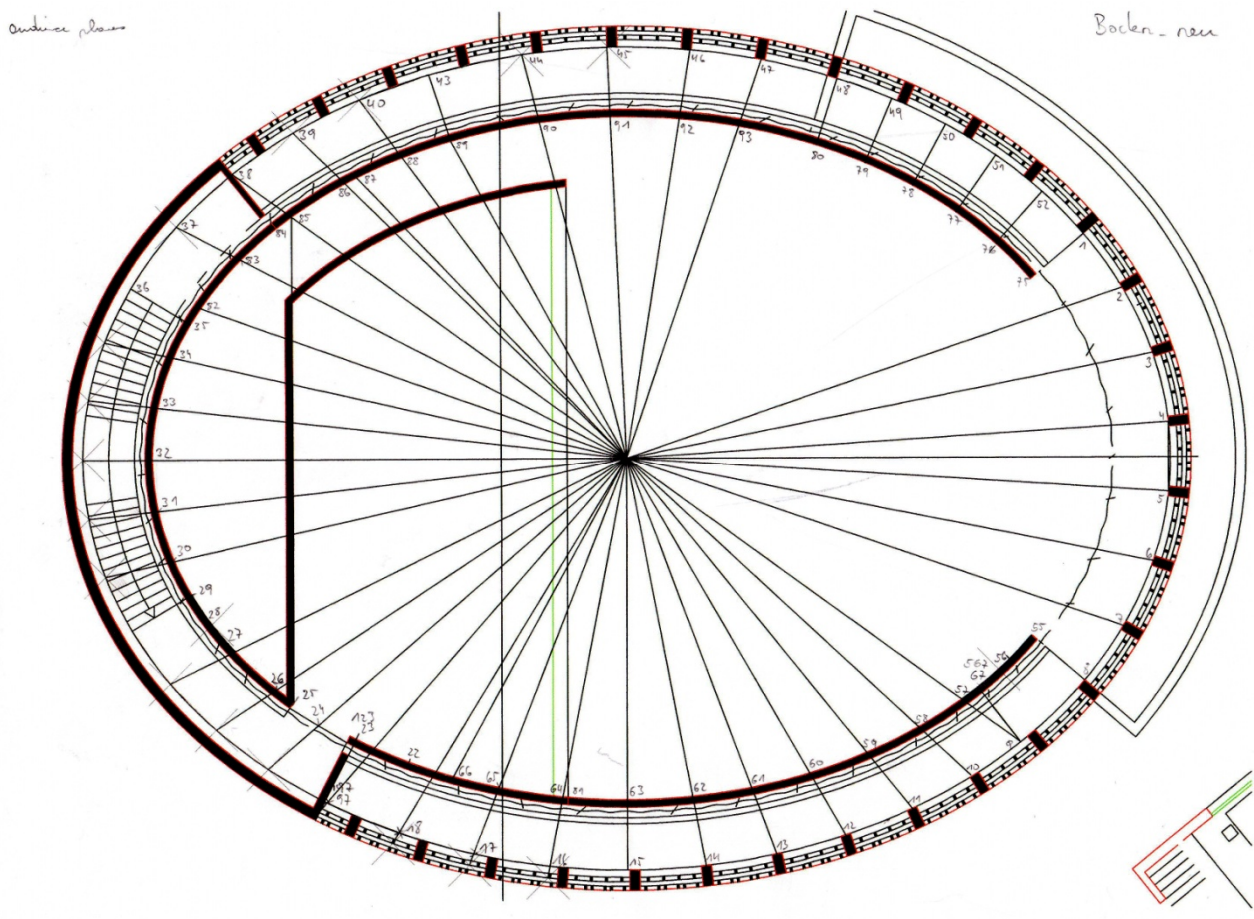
Grundriss des Raums mit eingezeichneten Punkten des Bodens [vgl. JAHRMANN]
